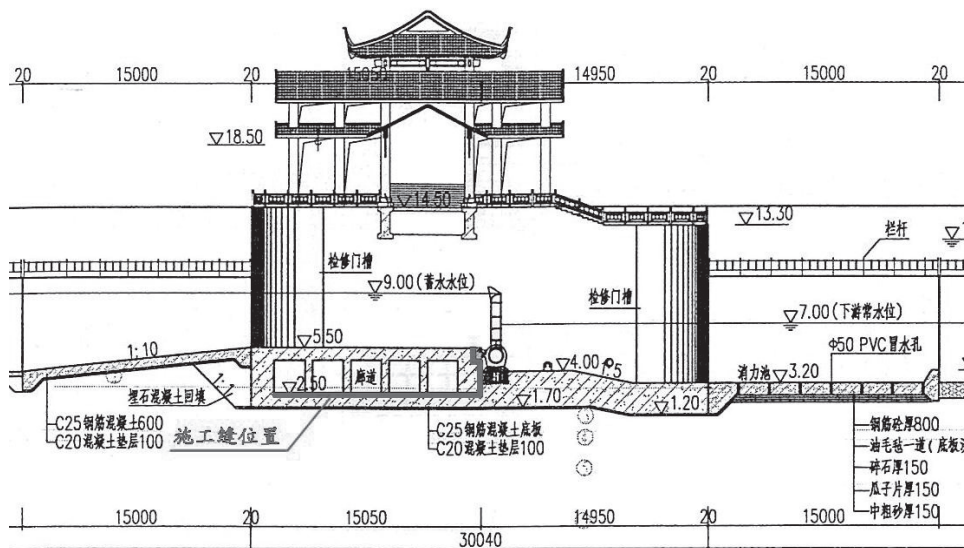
闸室纵剖面图 (施工缝布置位置示意图)
